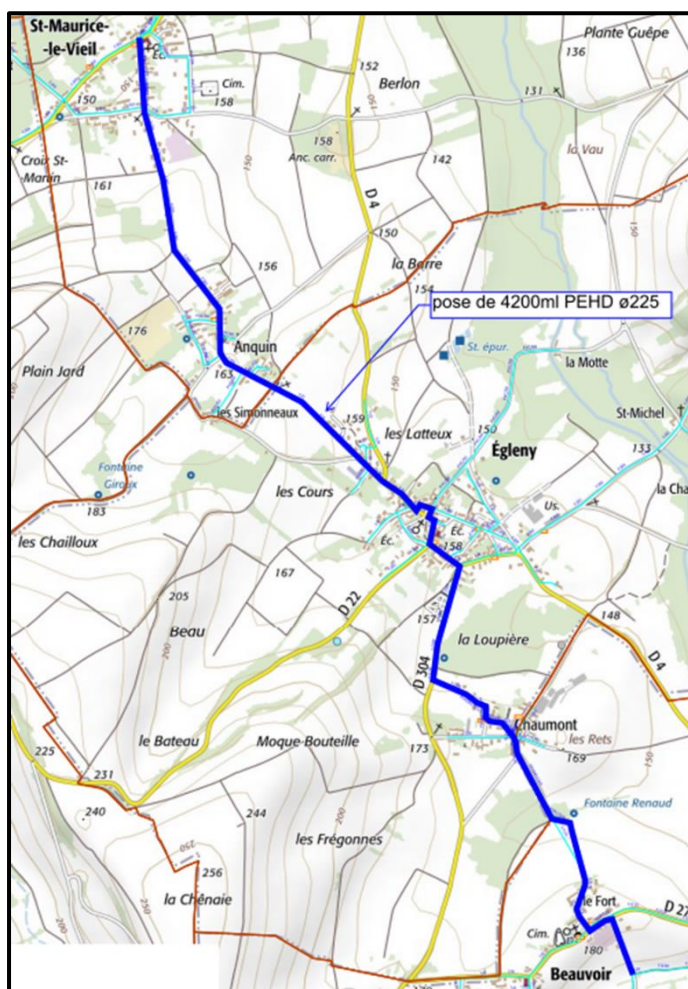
Plan du renouvellement de réseau entre Beauvoir et Saint-Maurice-le-Vieil
